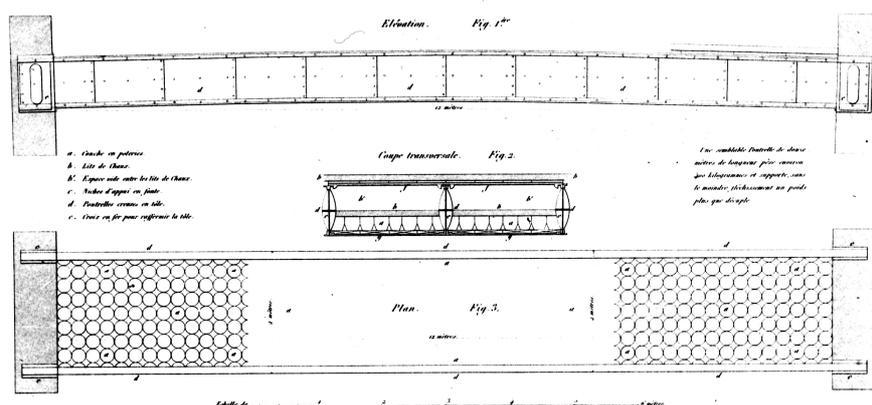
Trave a parete piena in lamiera, con pronunciata monta ed irrigidimenti. Riempimento dei campi in vasetti laterizi<sup>22</sup>
